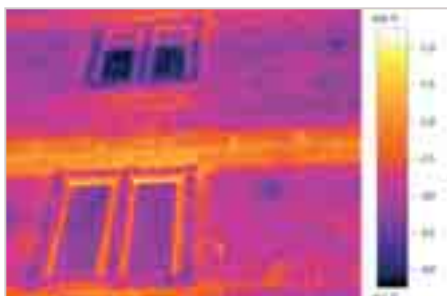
Теплопроводные включения в уровне межэтажных перекрытий
